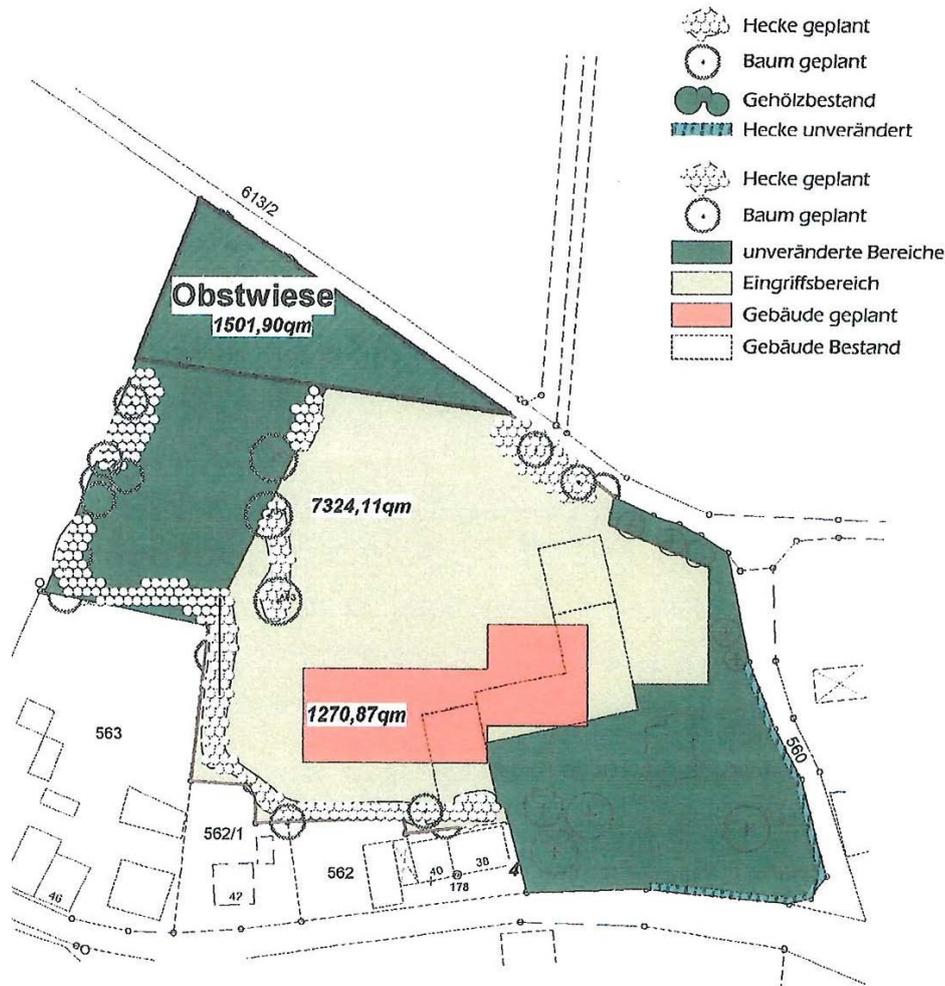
Ausschnitt Freiflächengestaltungsplan zum BV Neubau einer Hundesporthalle
